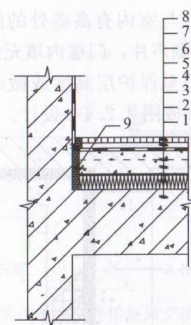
厨房间浮筑楼板保温隔声系统构造 (玻璃棉)
